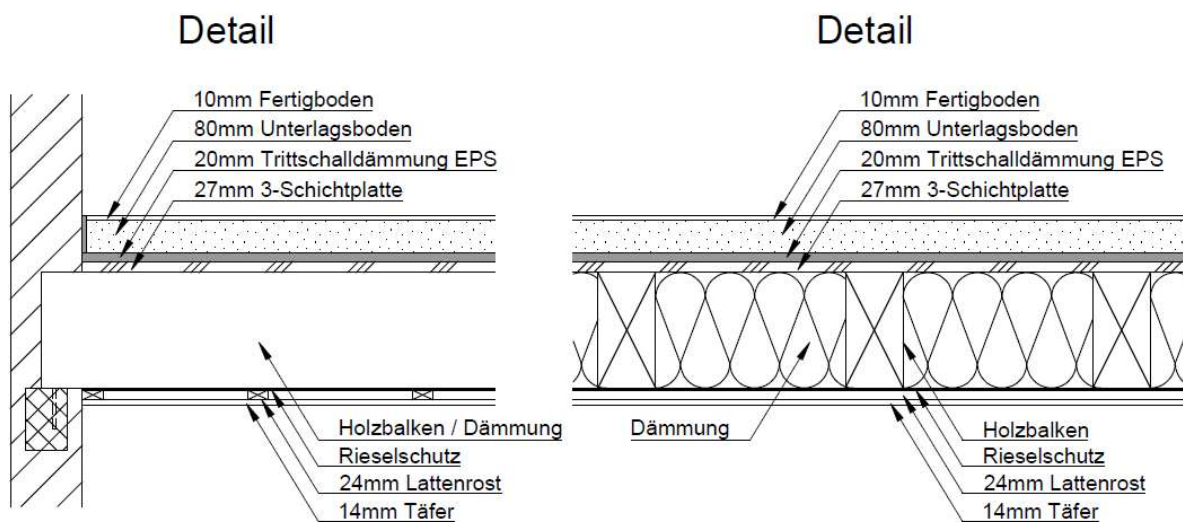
Aufbau Holzdecke (eigene Darstellung)
